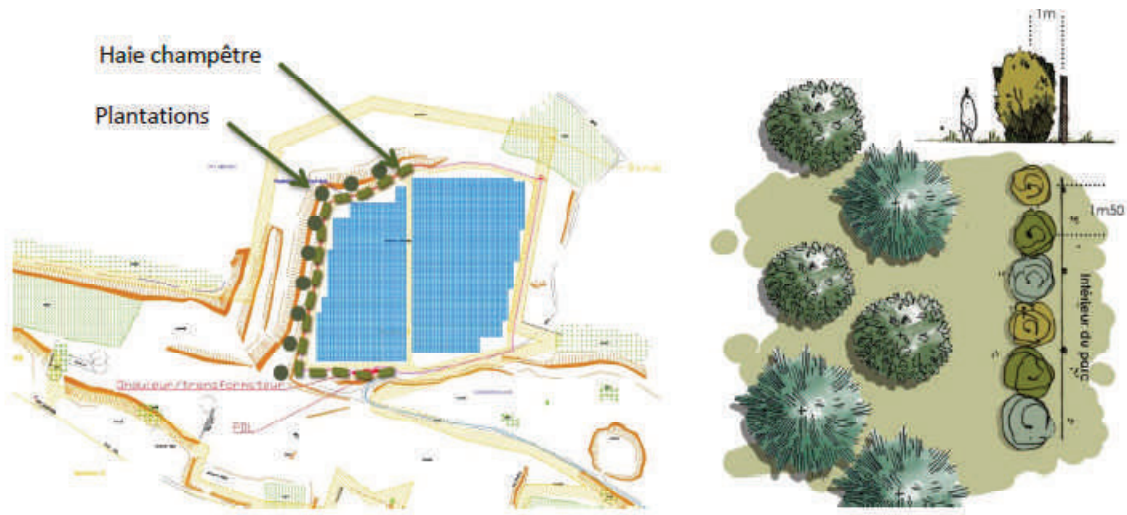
Plan de repérage et principe de plantation de la haie champêtre
